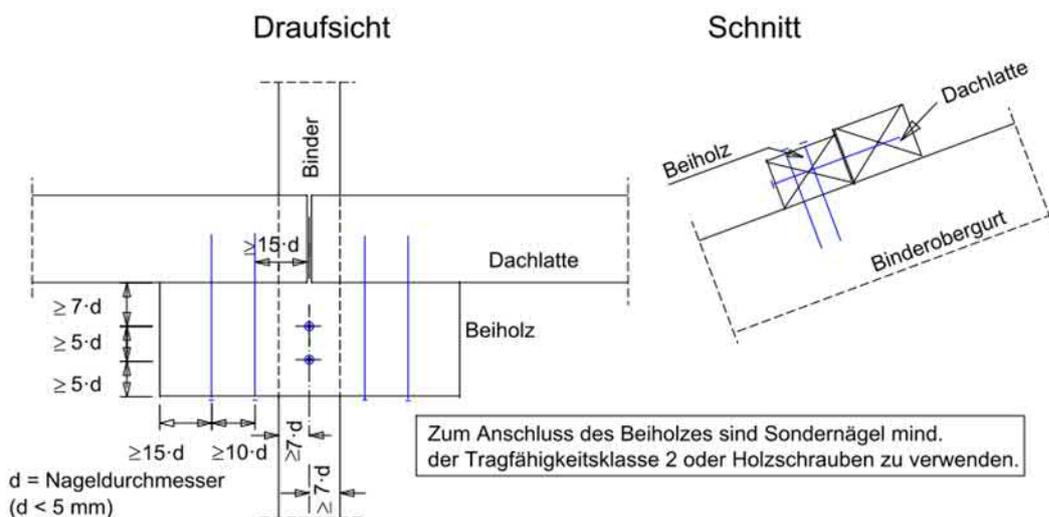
Tragender Stoß einer Dachlatte mit einem Beiholz; Mindestabstände für nicht vorgebohrte Nägel  $d < 5 \text{ mm}$  (dargestellt sind die Mindestnagelanzahlen)
